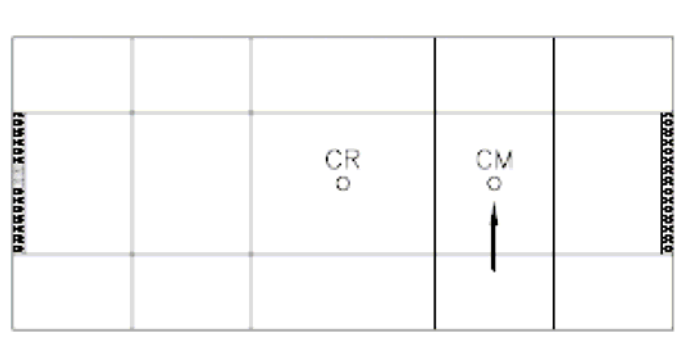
Edificio porticado con falta de simetría en planta por la presencia de un núcleo exterior que contiene los ascensores.
